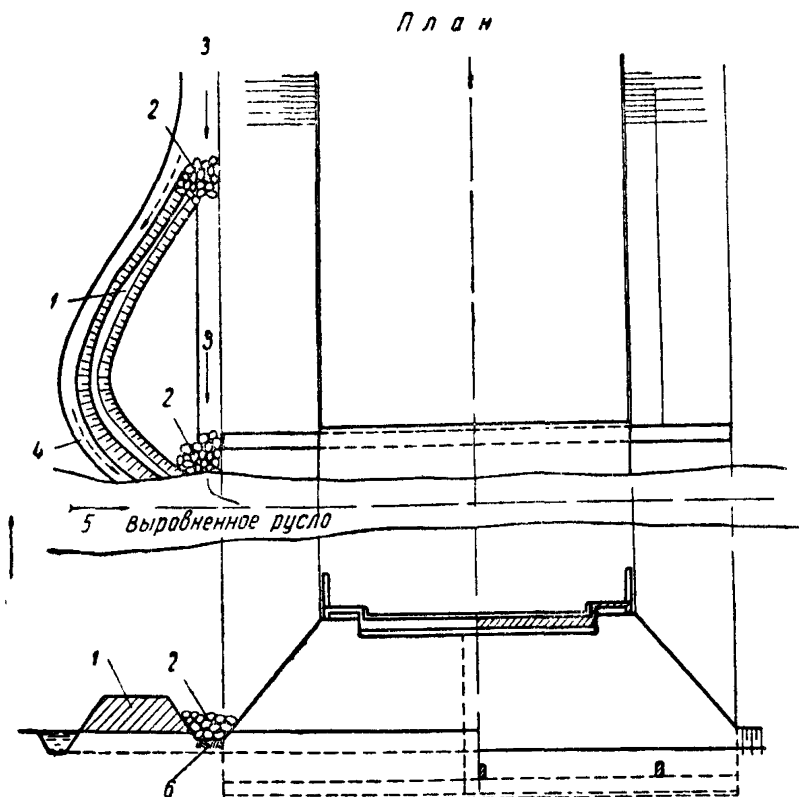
Схема мероприятий для повышения устойчивости оснований опор облегченных бетонных мостов:
